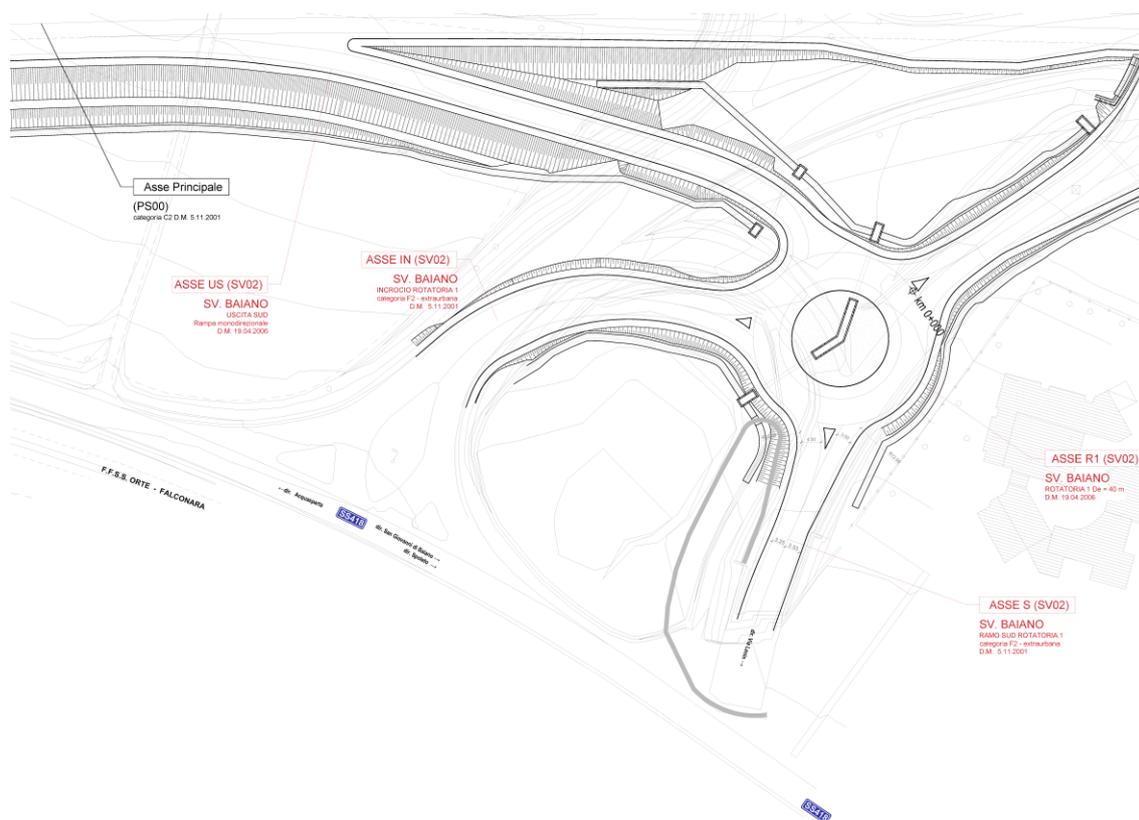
Svincolo di Baiano stralcio della planimetria di progetto lato sud
